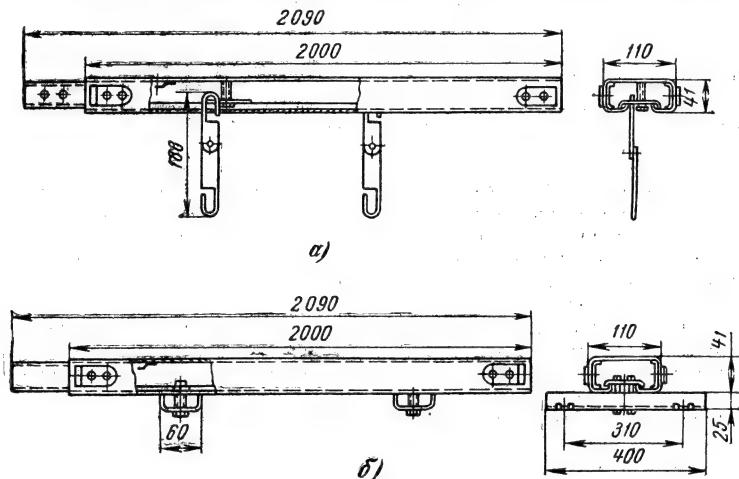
Короба для подвески светильников с люминесцентными лампами.
